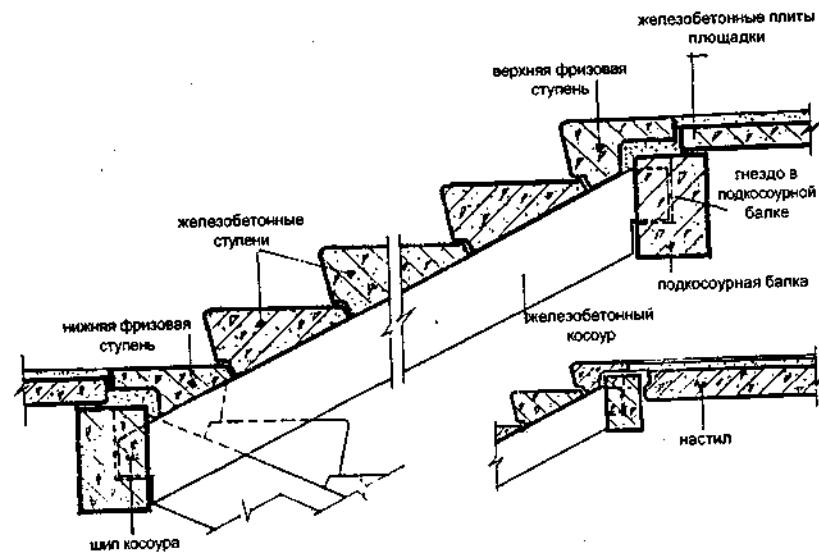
Мелкоэлементная лестница по железобетонным косоурам
